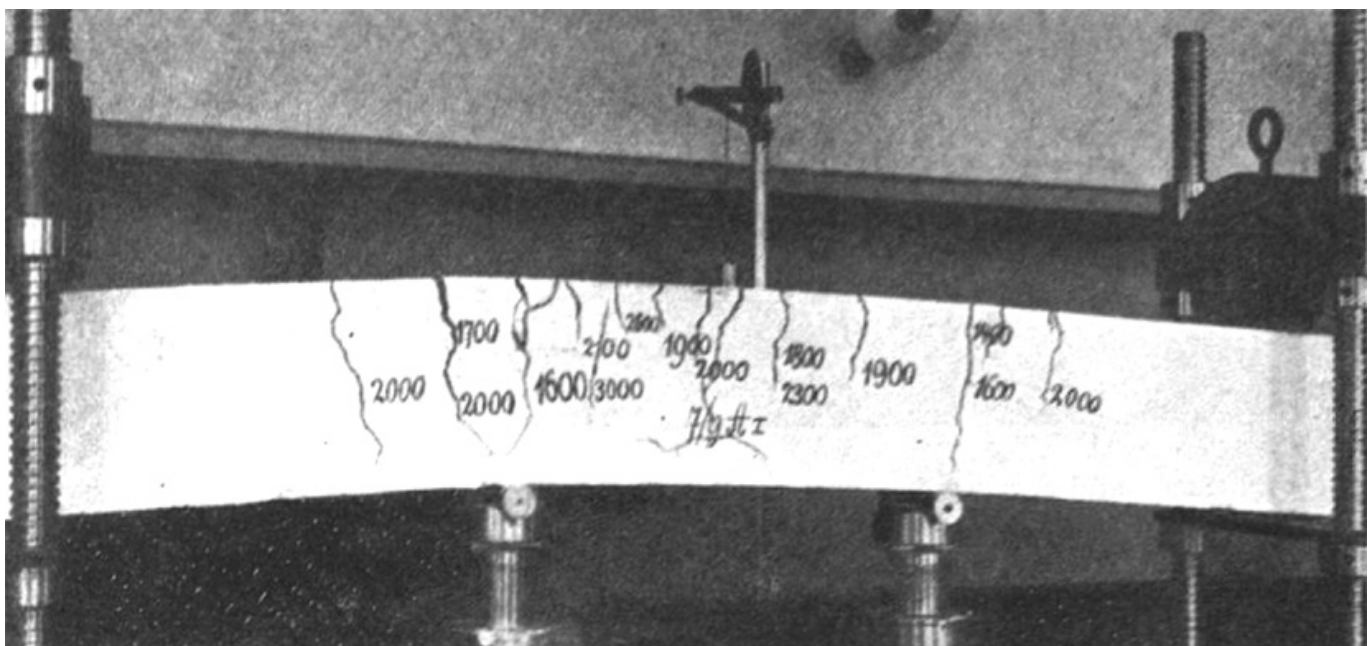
Laboranordnung für einen Bruchversuch an einem bewehrten Betonbalken (Eisenbeton-Ausschuß Österreich 1912, S. 105).
